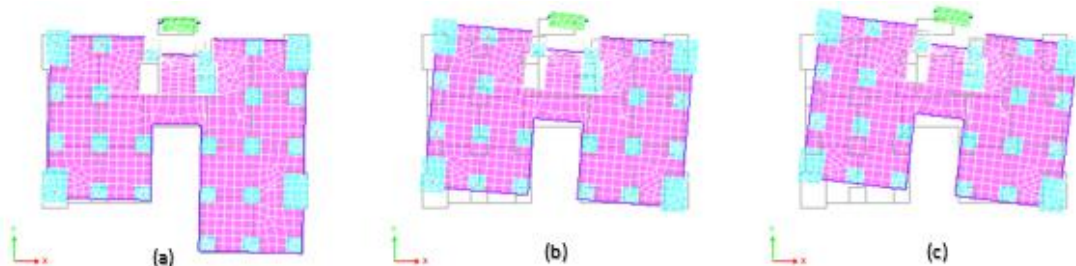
Vista en planta del modo de vibración 2 correspondiente al Caso 4. a) Segunda Planta. b) Quinta Planta. c) Octava Planta.
